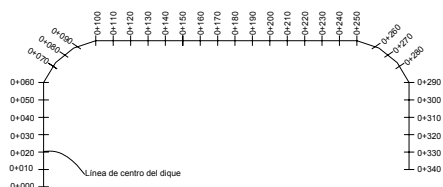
Vista en planta para P.H. Cariblanco. (P.H. Cariblanco).
